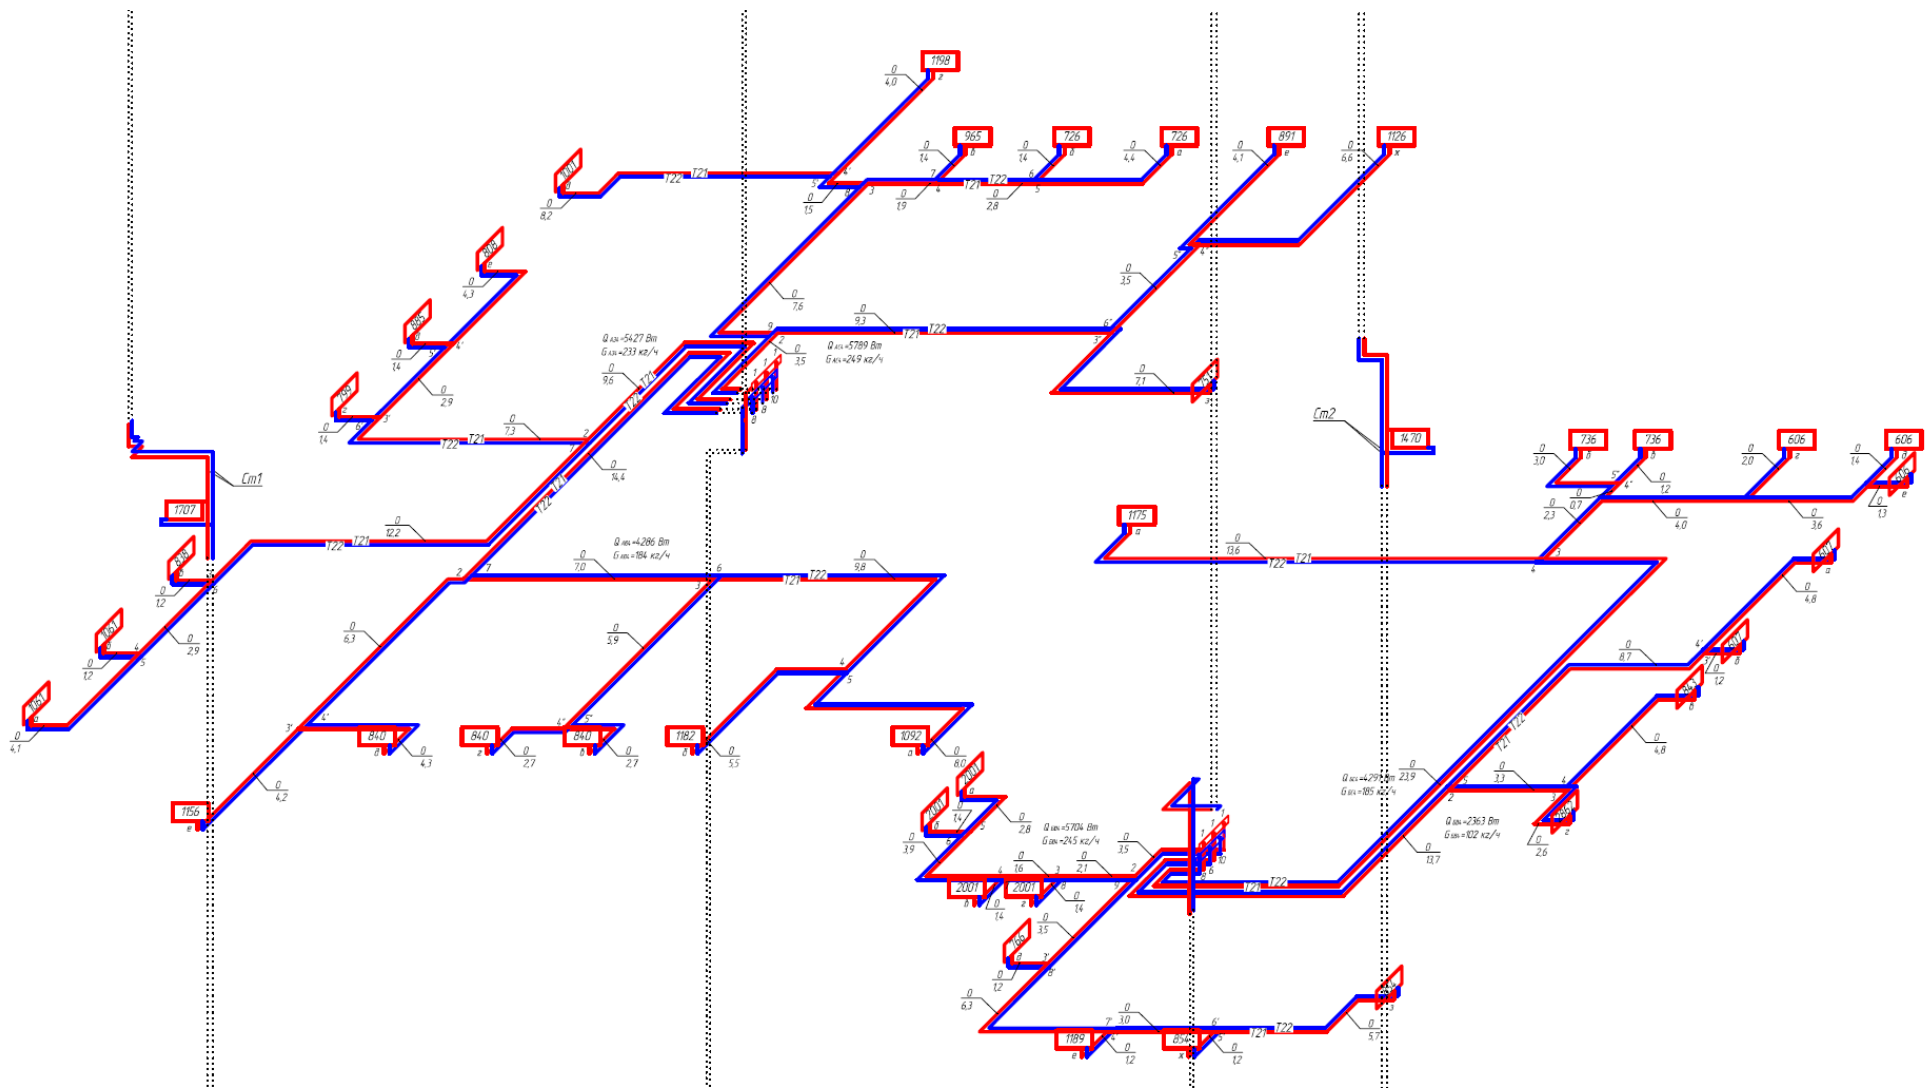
Расчетная схема системы отопления 1 этаж
